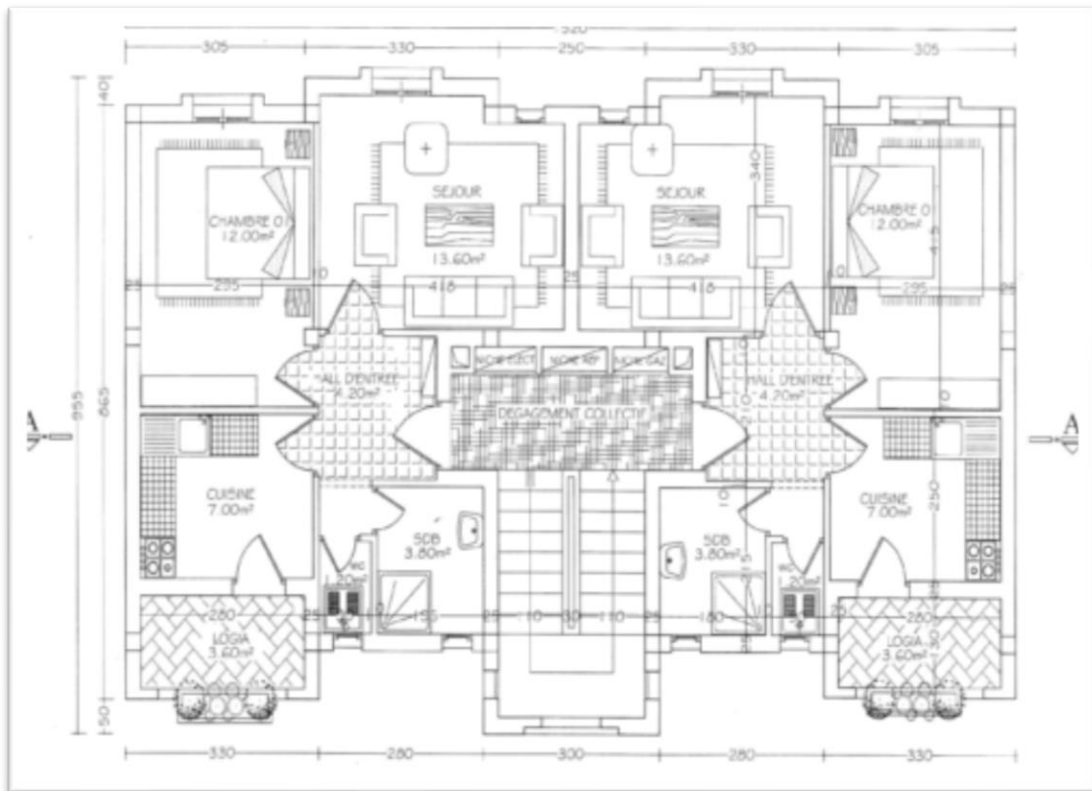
Plan d'architecture 2 F2, cité 136/1200 logements – ville nouvelle de Bellil
